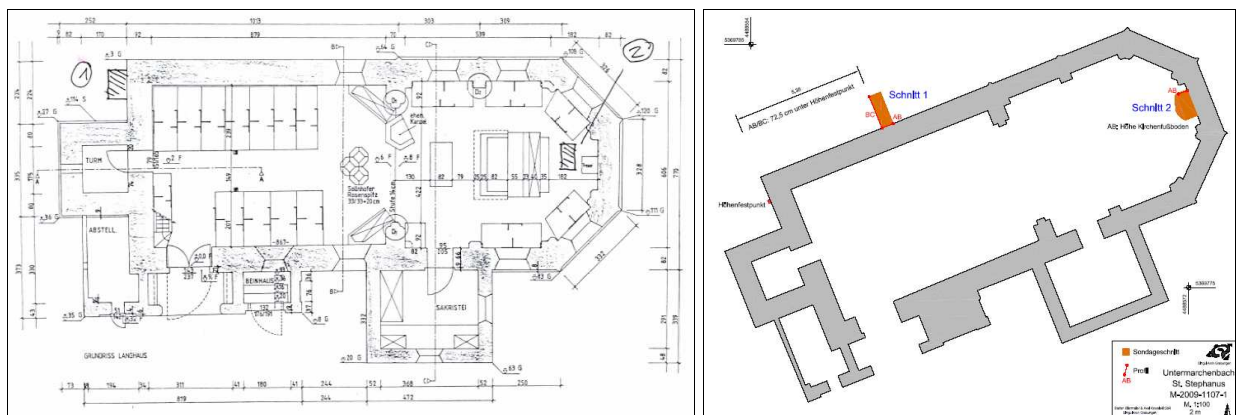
Links: Plan der Kirche mit Einzeichnung der geplanten Sondagen.
